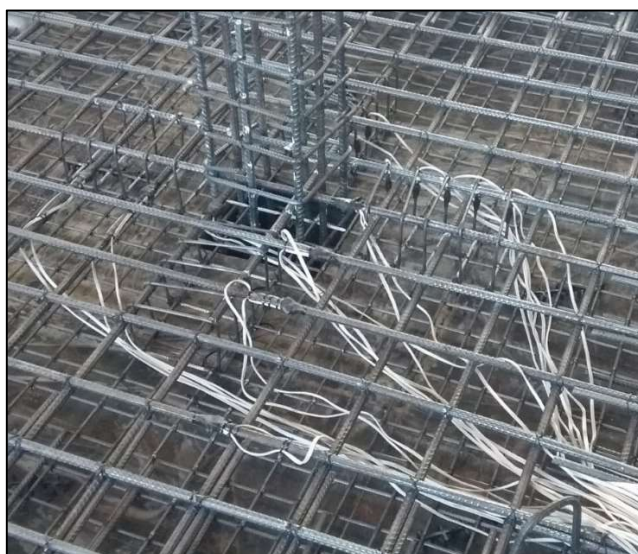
Extensômetros fixados nas armaduras de flexão e cisalhamento
